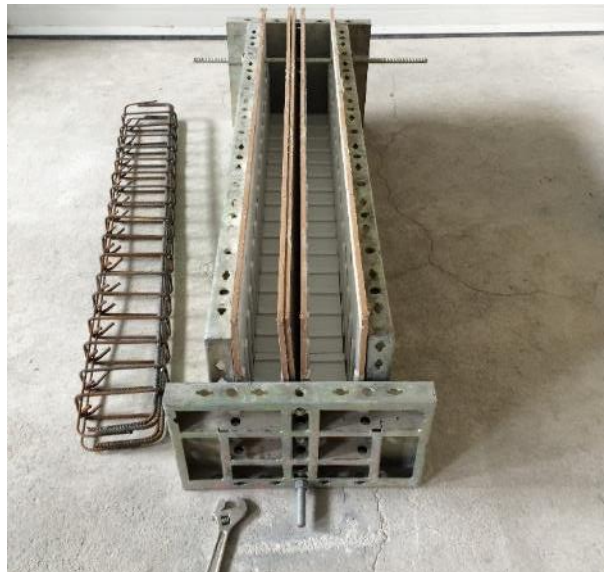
Aspeto das armaduras utilizadas nas vigas
